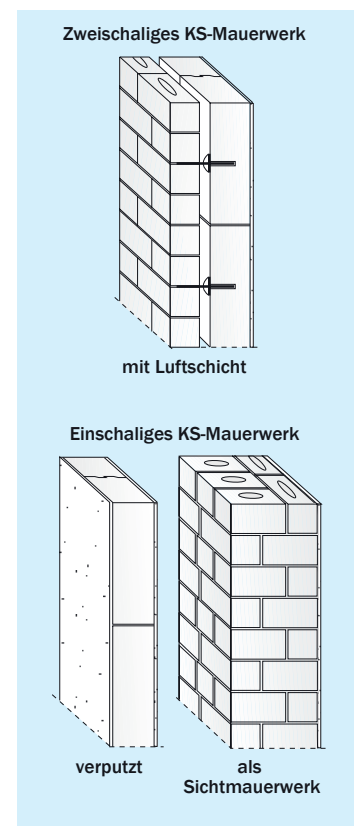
KS-Außenwandkonstruktionen für niedrig oder nicht beheizte Gebäude
